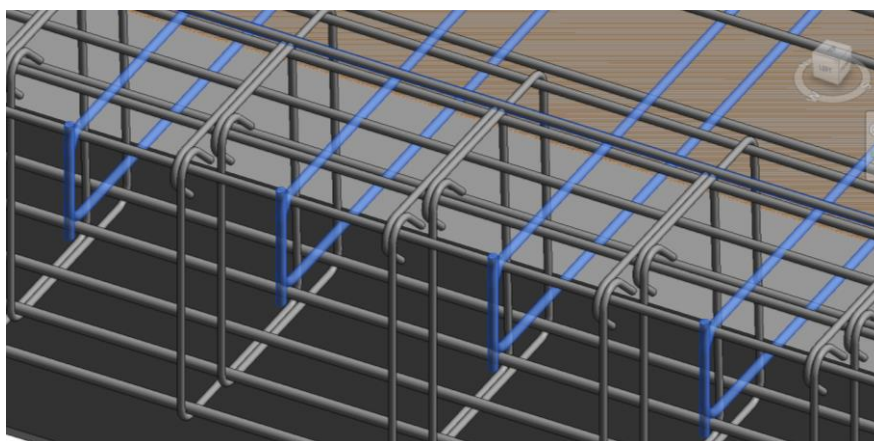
Pormenor da sobreposição das armaduras superior e inferior da laje.
